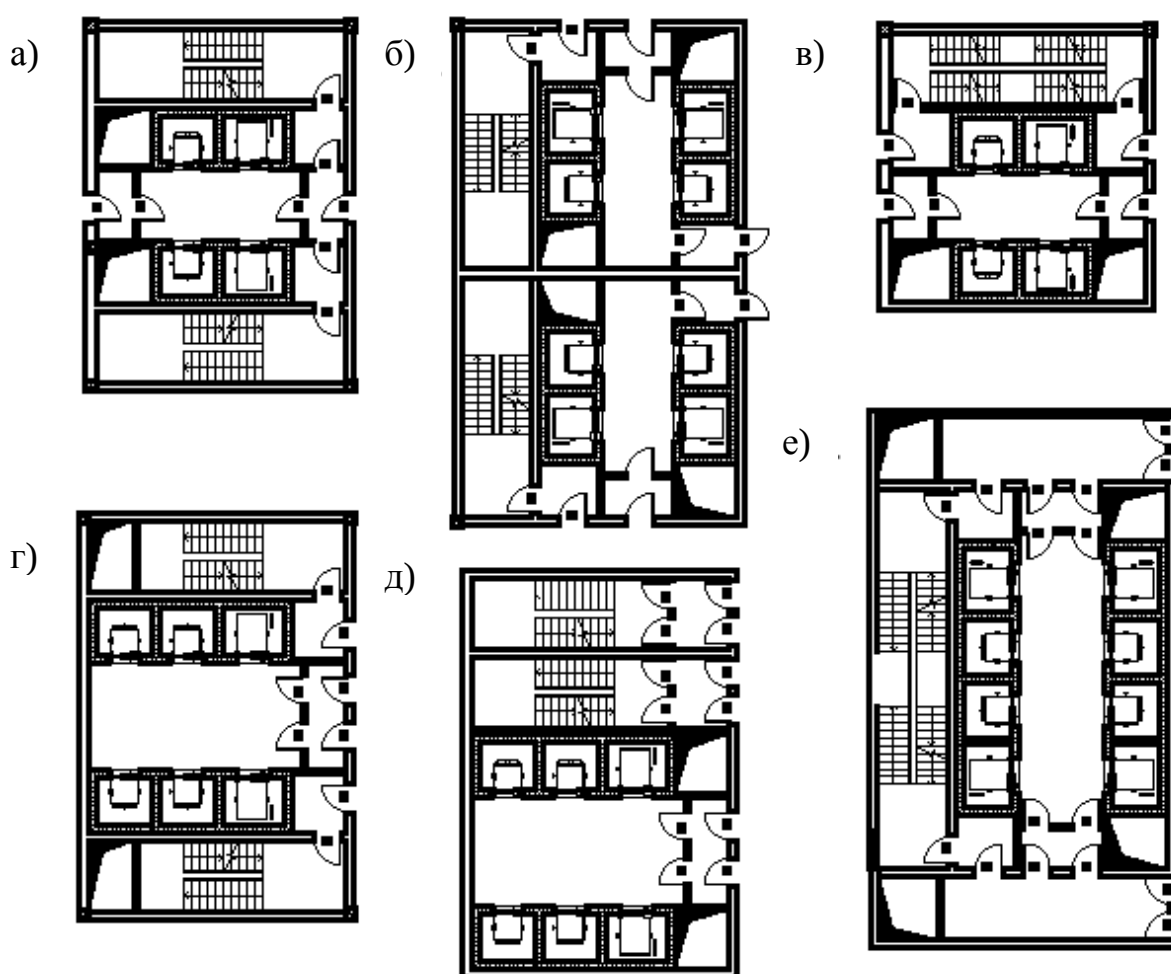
Архитектурно-планировочные решения лестнично-лифтовых узлов высотных зданий: а – раздельное размещение лестничных клеток; б – смежное размещение лестничных клеток; в – совмещенное размещение лестничных клеток; г – раздельное размещение лестничных клеток в отдельных объемах; д – смежное размещение лестничных клеток; е – совмещенное размещение лестничных клеток
